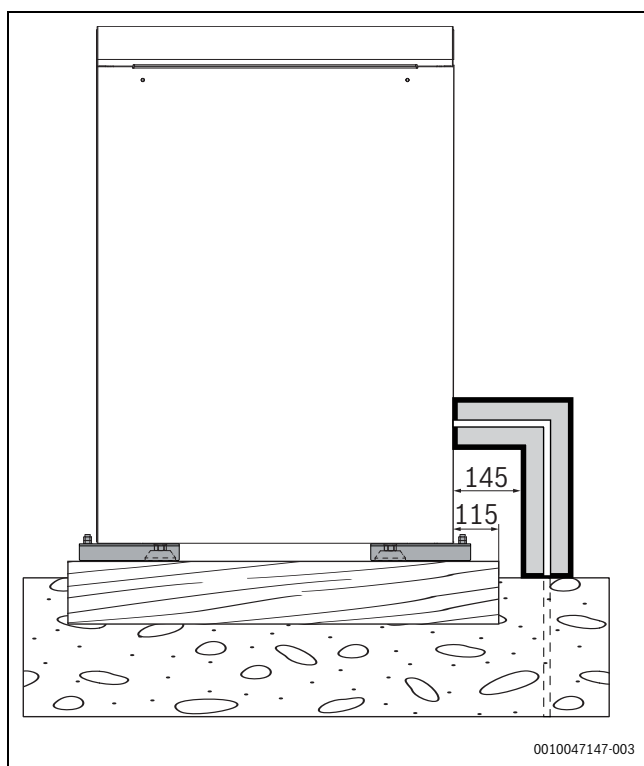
Seitenansicht mit Installationspaket (INPA) und Dämmschalen
